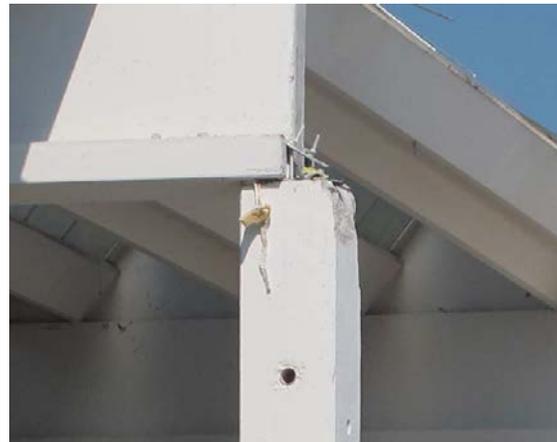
Perdita di appoggio della trave per rottura connessione in un edificio con trave principale trasversale
